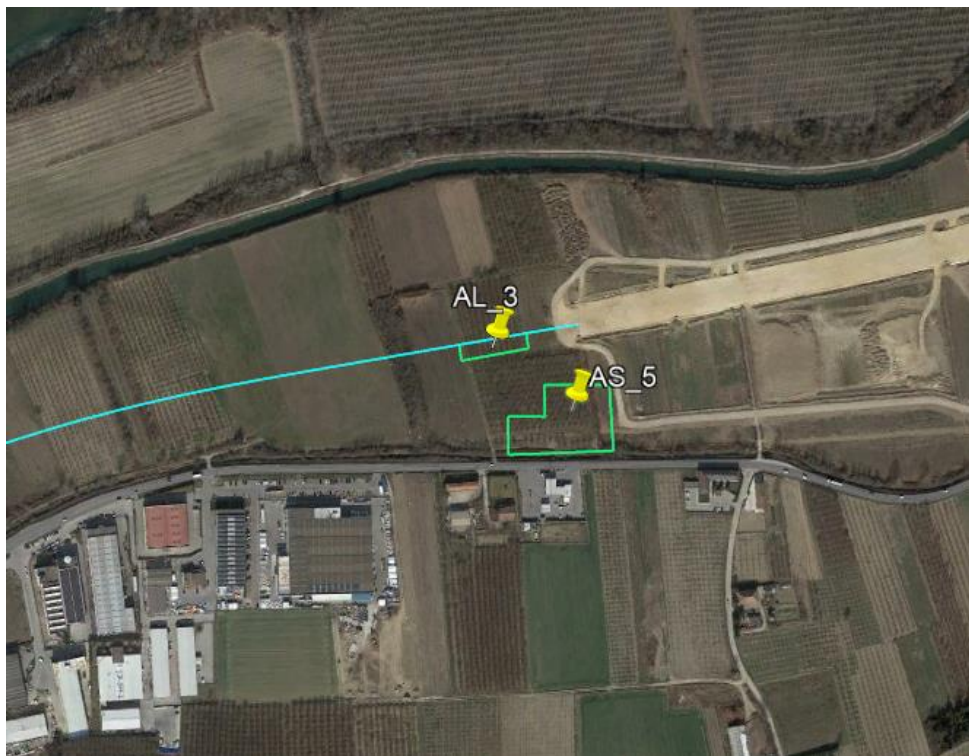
Rappresentazione aree di cantiere – Scenario 2
